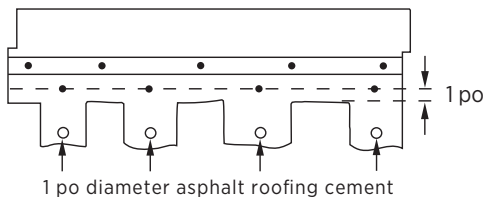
Fixation des bardeaux Presidential et Bardeaux Presidential T/L sur les fortes pentes.
